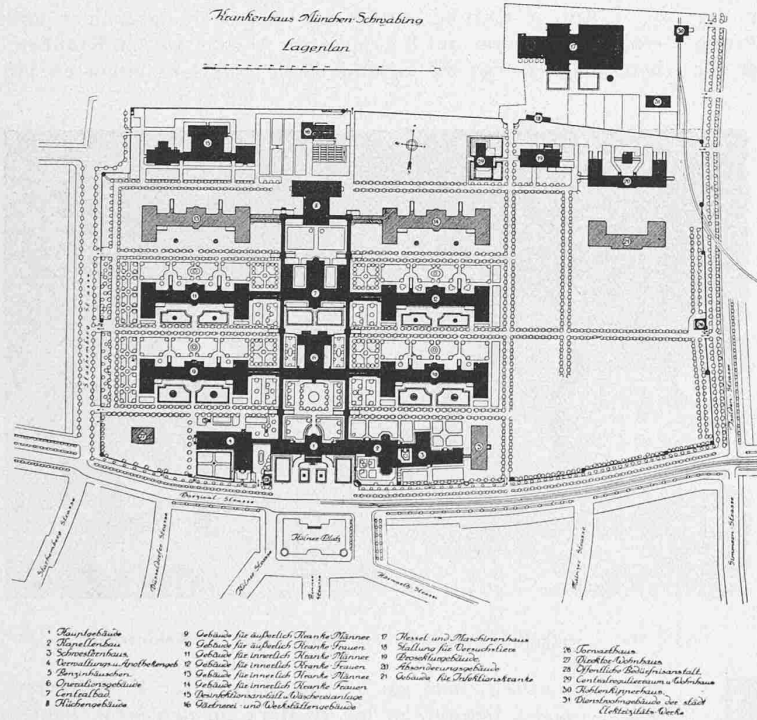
Krankenhaus Schwabing. — Lageplan 1:6500.
